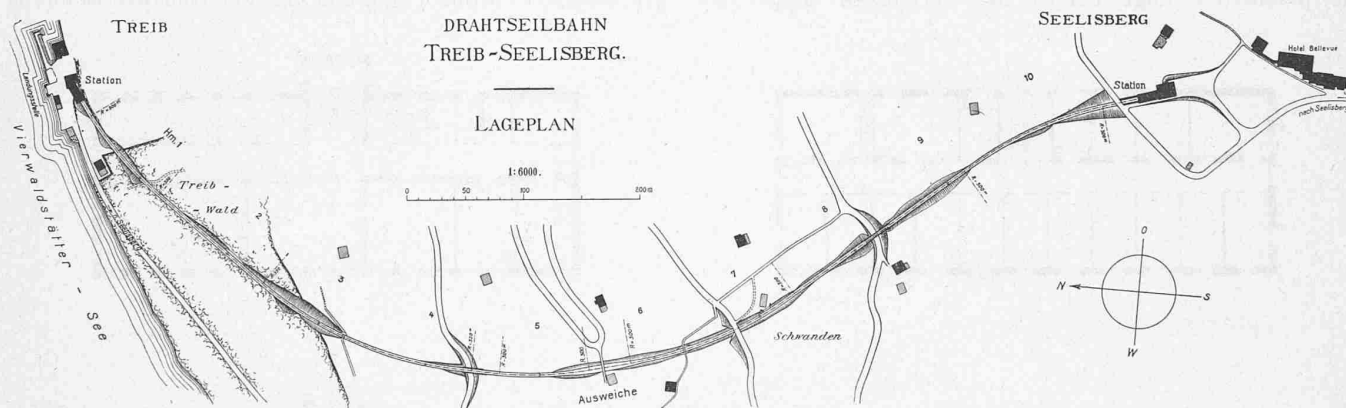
Lageplan der Treib-Seelisberg-Bahn. — Masstab 1 : 6000.
